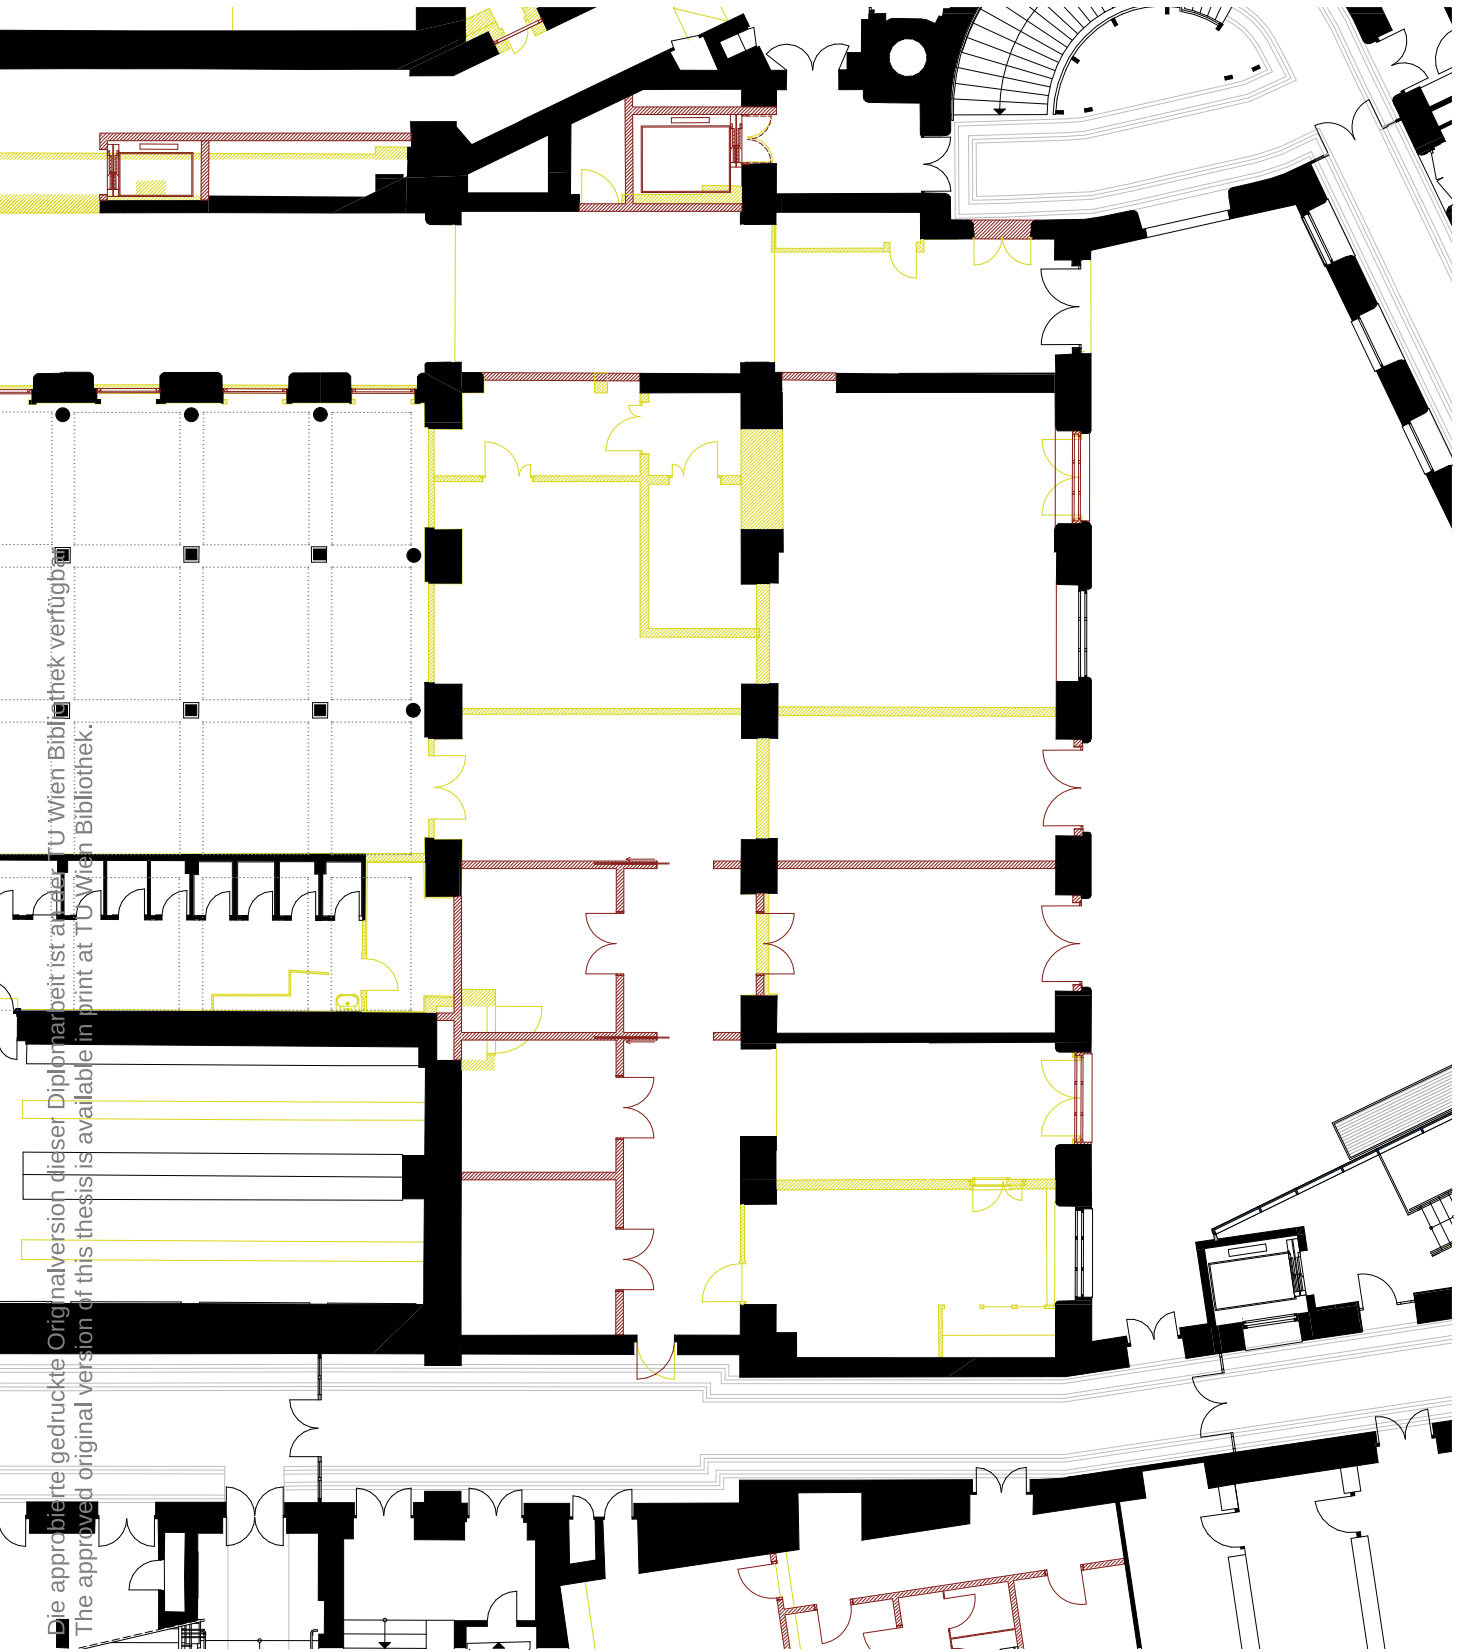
Entwurfsplan Grundriss Tiefparterre
